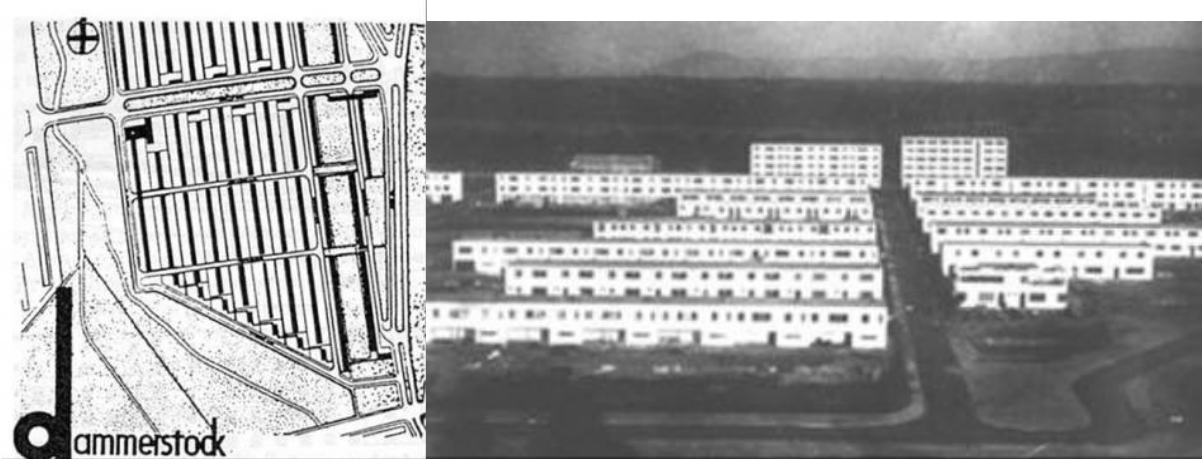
e 228 – SIEDLUNG DE DAMMERSTOCK – PLANTA E VISTA, 1928
